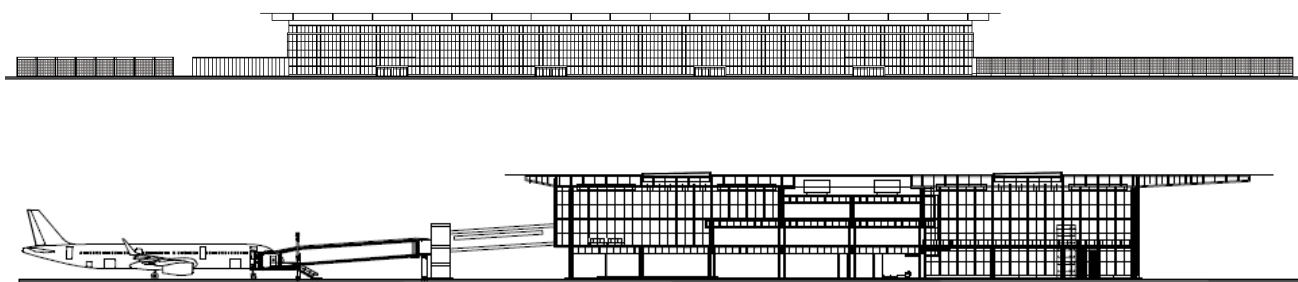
Prospetto land-side (in alto) e sezione (in basso) del Nuovo Terminal
